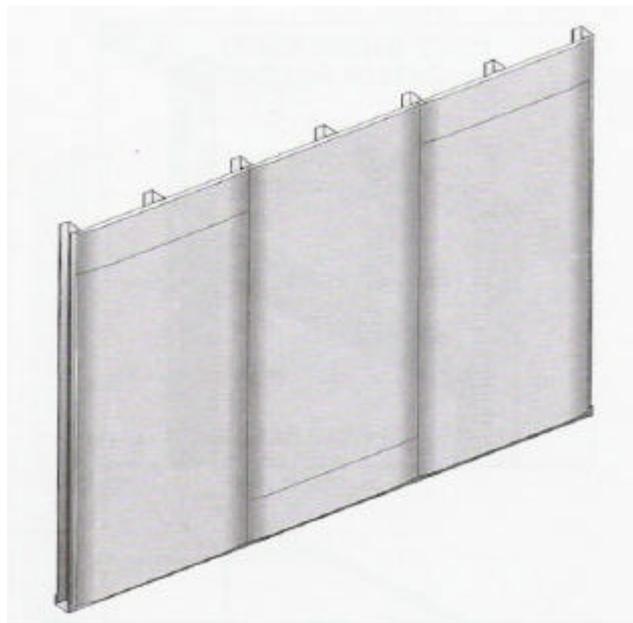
Desencontro de juntas horizontais em painel. Fonte: Abragesso, 2004.
